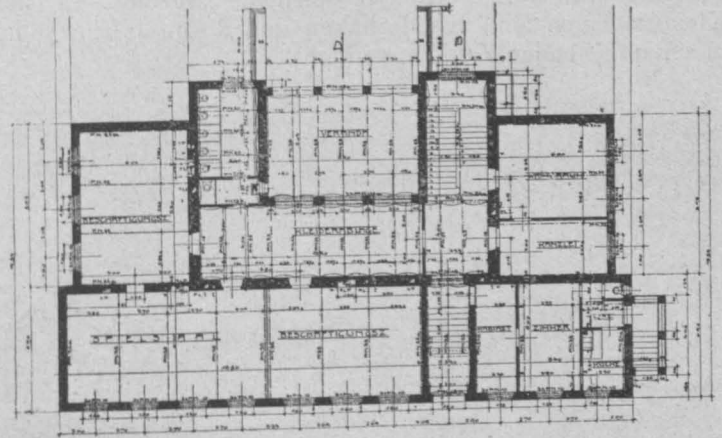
Erdgeschoß Grundriß zu Abb. 35.
